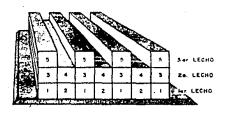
SECUENCIA DE COLADO DE PILOTES DE SECCION CUADRADA
